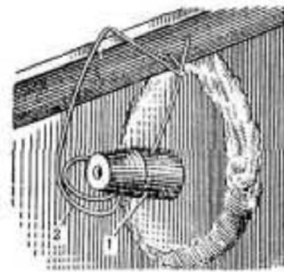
Контровка штырей главных ферм с помощью запорных булавок:
